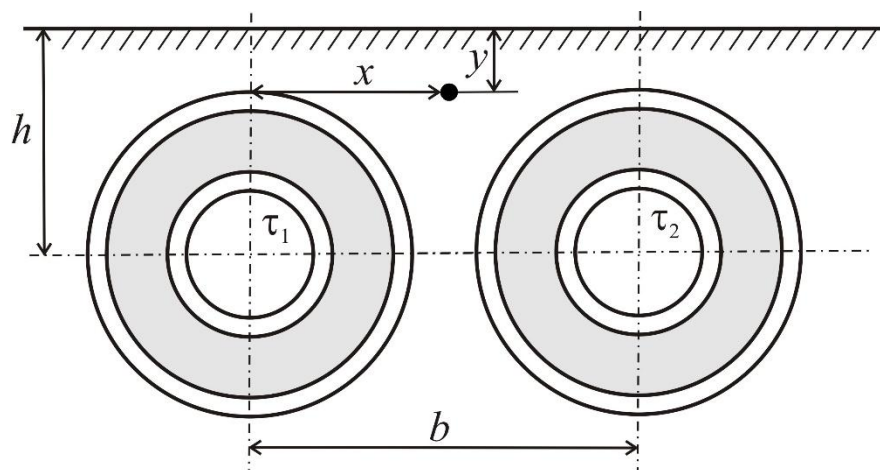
Схема двухтрубного бесканального теплопровода
